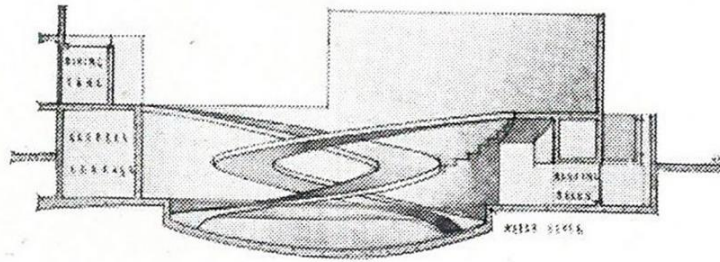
Sección de la planimetría del proyecto Piscina para pingüinos en el Zoológico de Londres. Arquitecto. Berthold Lubetkin.
